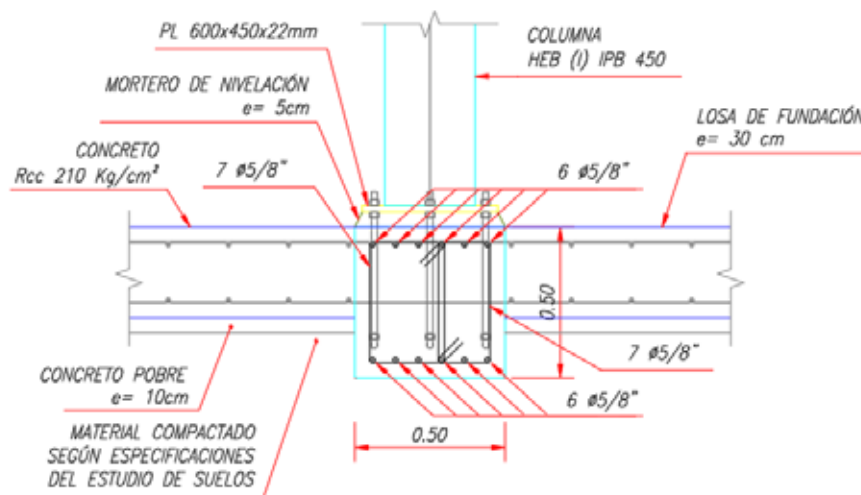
Detalle de Losa de Piso con Columna. (2016).
